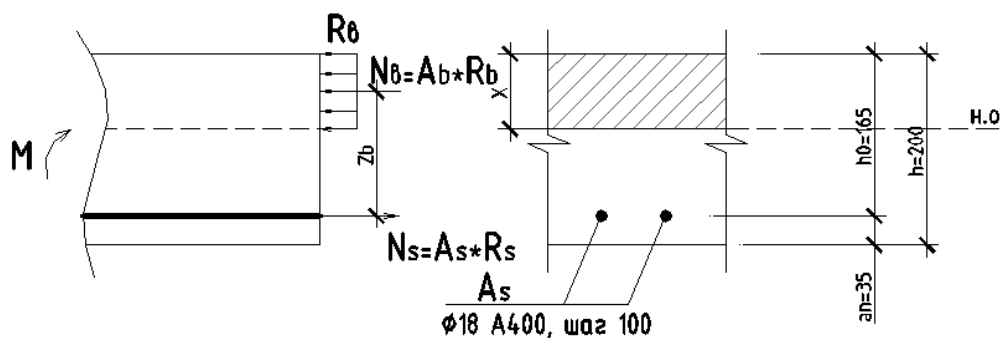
Схема внутренних усилий плиты над залом в середине пролета
